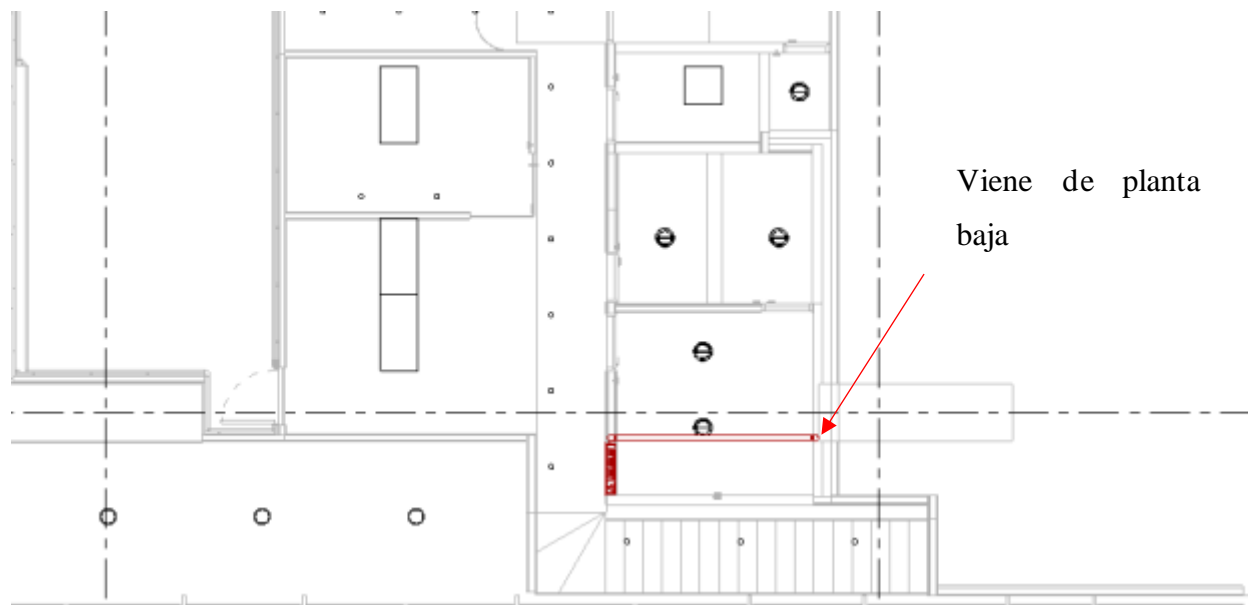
Distribución de tubería. Vista de planta, planta alta.
